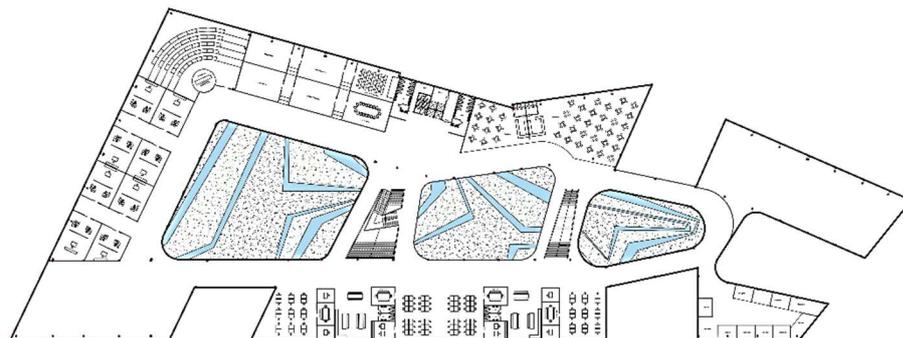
12 Plan RDC. Source :(Auteur, 2020)
